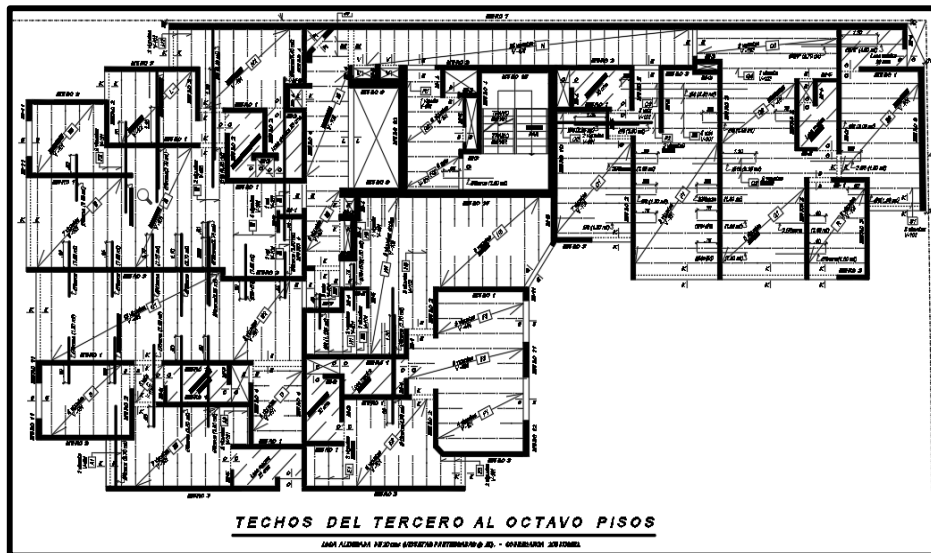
Plano de Estructura (Viguetas) – Techo típico
